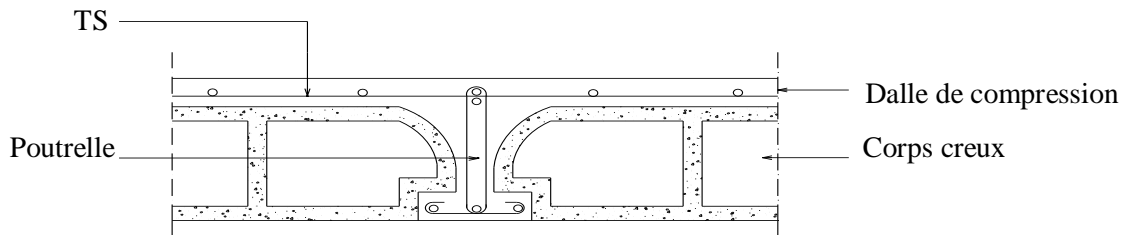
Coupe transversale d'un plancher à corps creux
